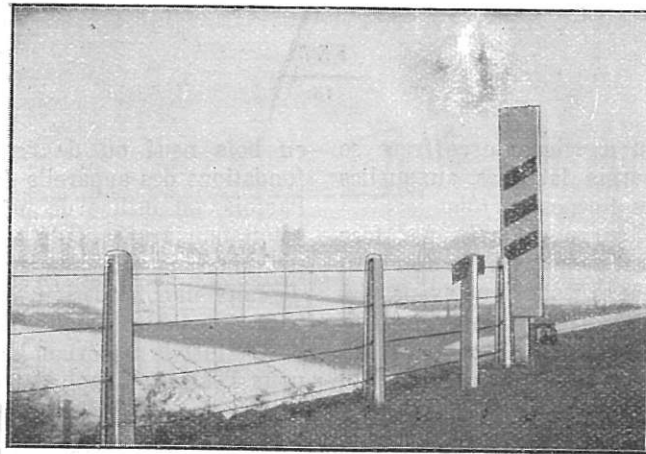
Barrière blanche pour signal avertisseur, poteau de pente et rampe, clôture avec poteaux en béton.
